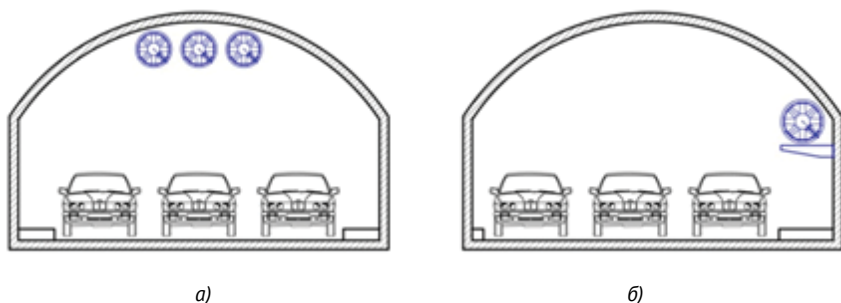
Продольная схема противодымной вентиляции автодорожного тоннеля с применением струйных вентиляторов. Поперечный разрез.
